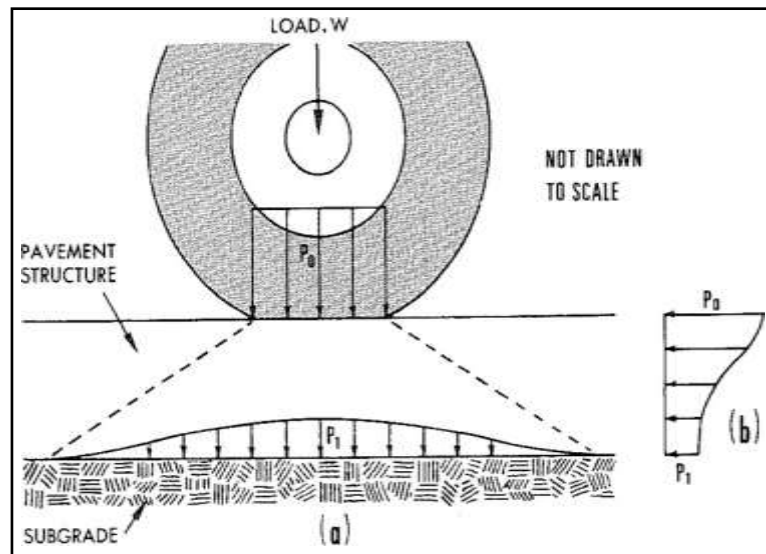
Deslizamiento de la presión de carga de rueda a través de la estructura de un pavimento flexible.
